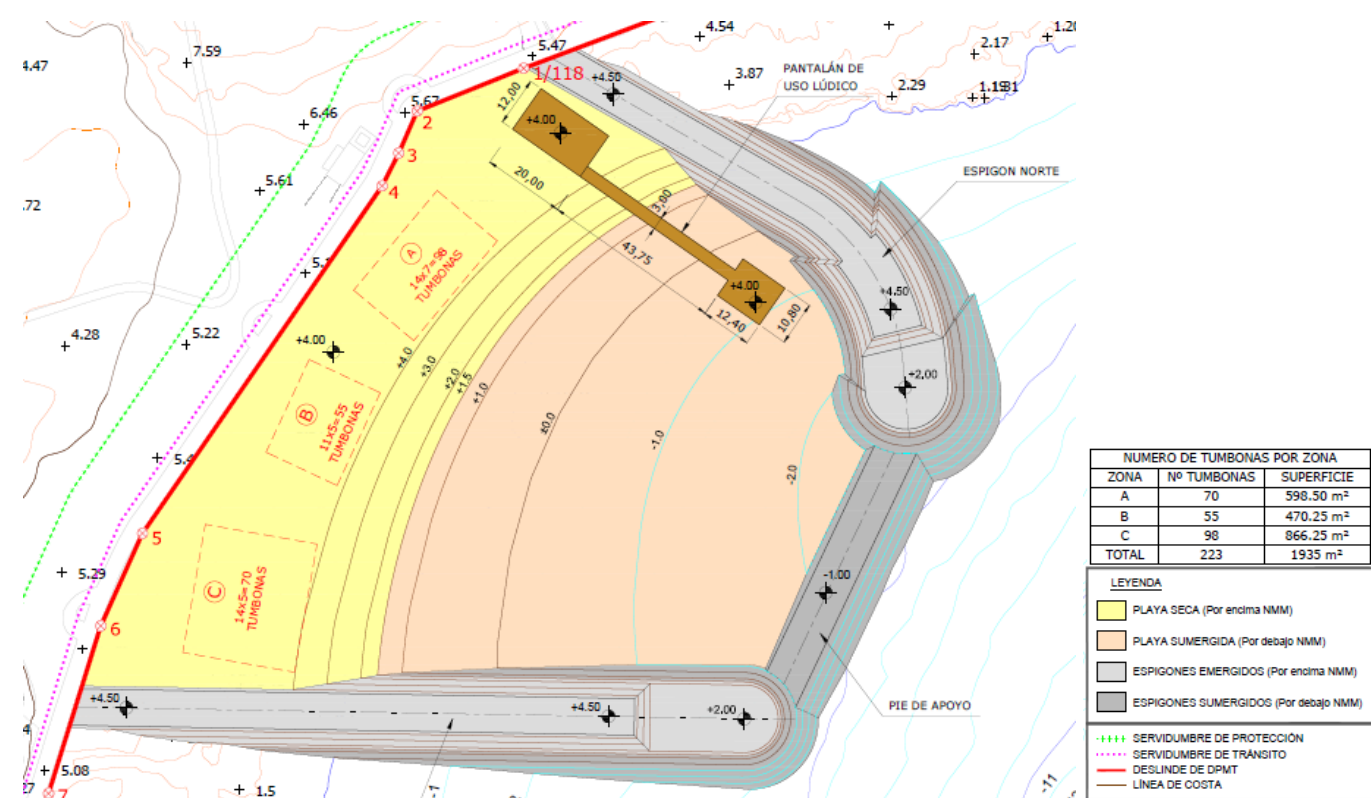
Planta de ordenación de la playa (Fuente: elaboración propia)
